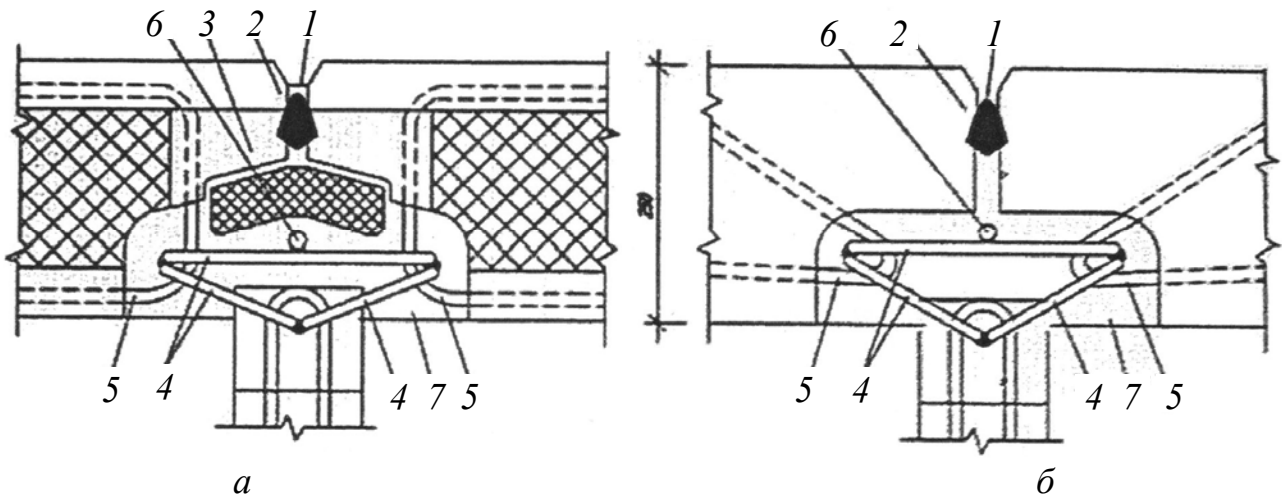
Конструкция вертикальных замоноличенных армированных стыков наружных стеновых панелей:
